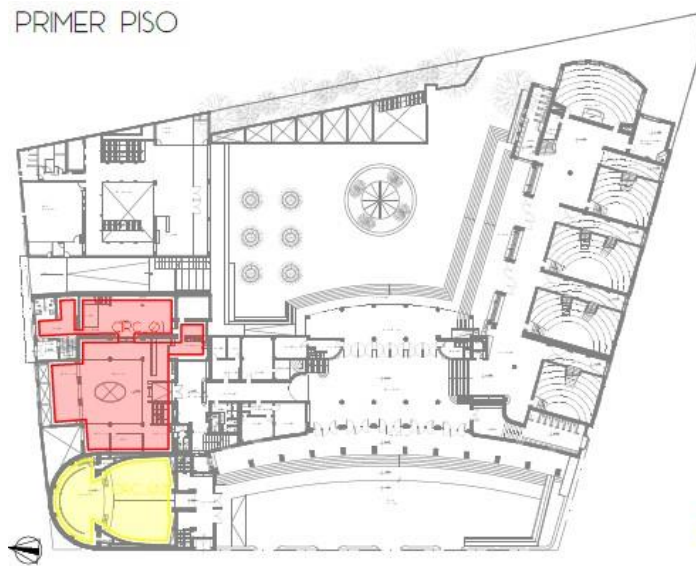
Planta esquema zonas climatizadas Primer Piso.
